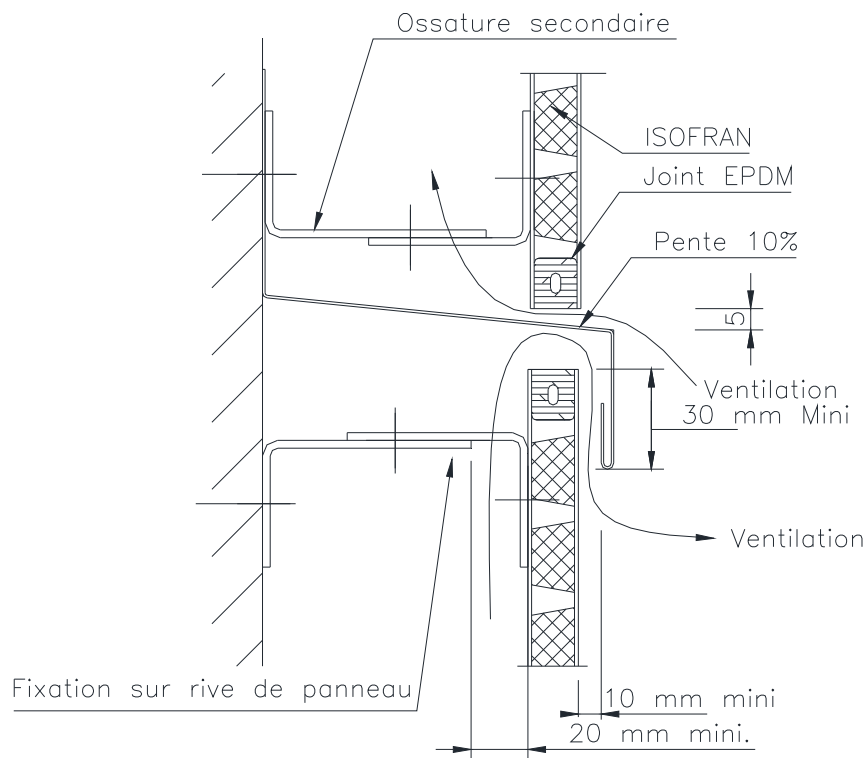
Panneau ISOFRAN à bords pliés Pose verticale - Bavette de raccord intermédiaire (côtes en mm)
